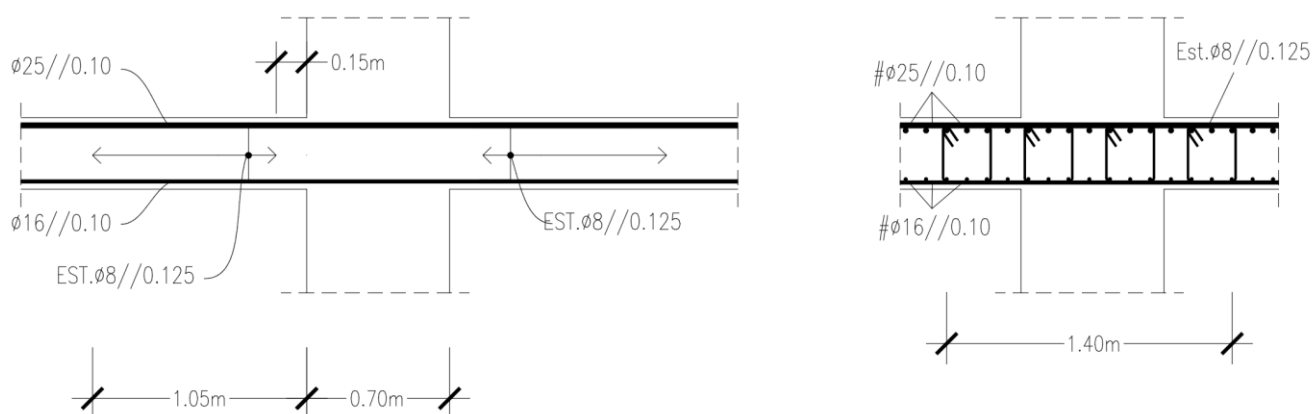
Pormenores das armaduras transversais, na direção X. Esquerda: Alçado; Direita: Corte.
